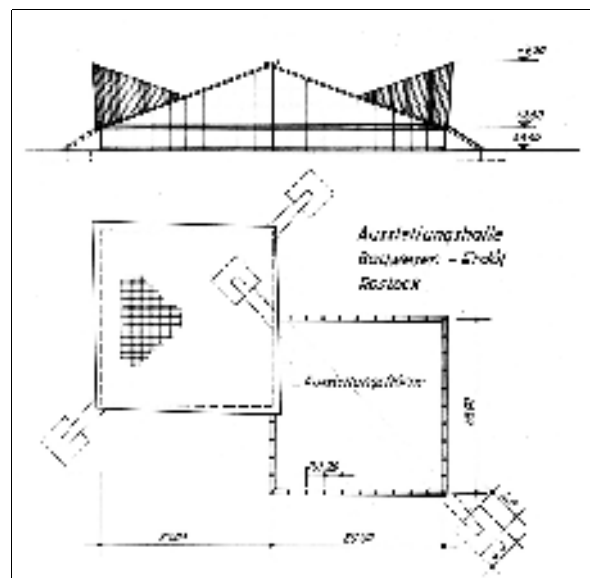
Erich Kaufmann und Ulrich Müther, Messehalle Bauwesen – Erdöl in Rostock-Schutow, Aufriss und Grundriss, um 1965
